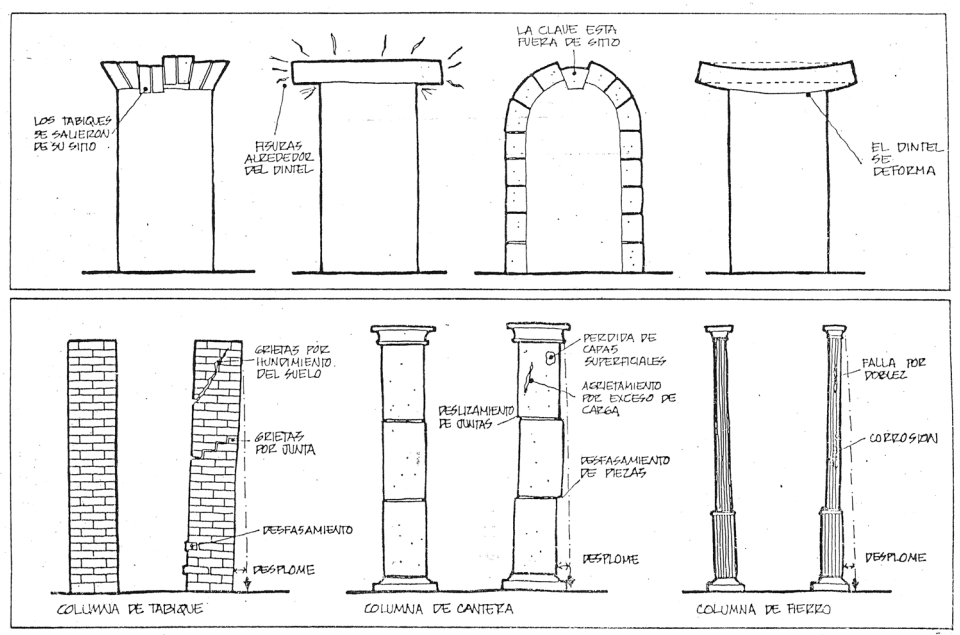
Tipos de daños en otros elementos constructivos. Imagen: (Rocha, 1985:22) ©INAH.
